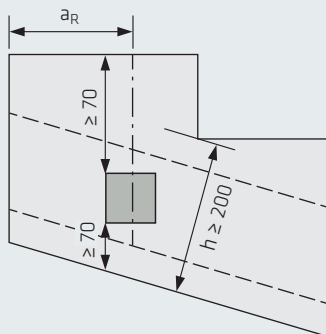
Mindestbauteilabmessungen HQW 60/40 Treppenkopf bzw. Treppenfuß
